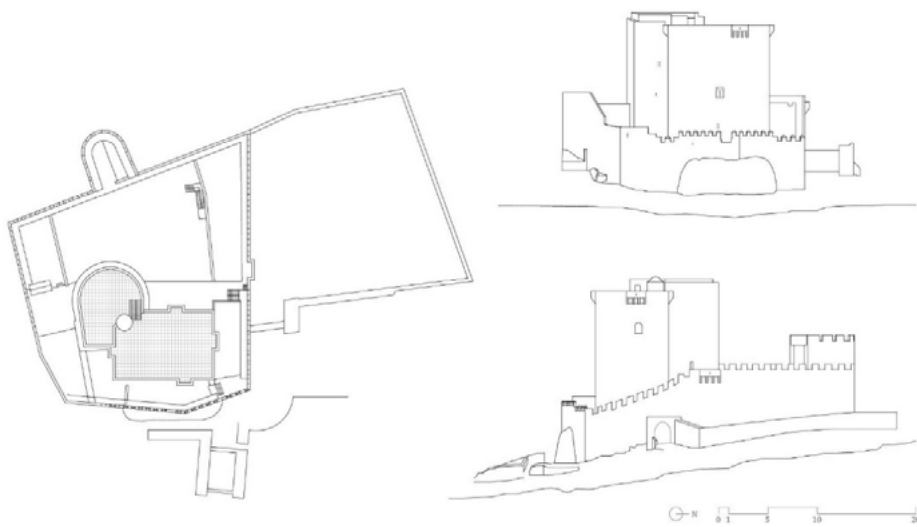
Ortoimágenes y planimetría del Castillo de los Dávila
